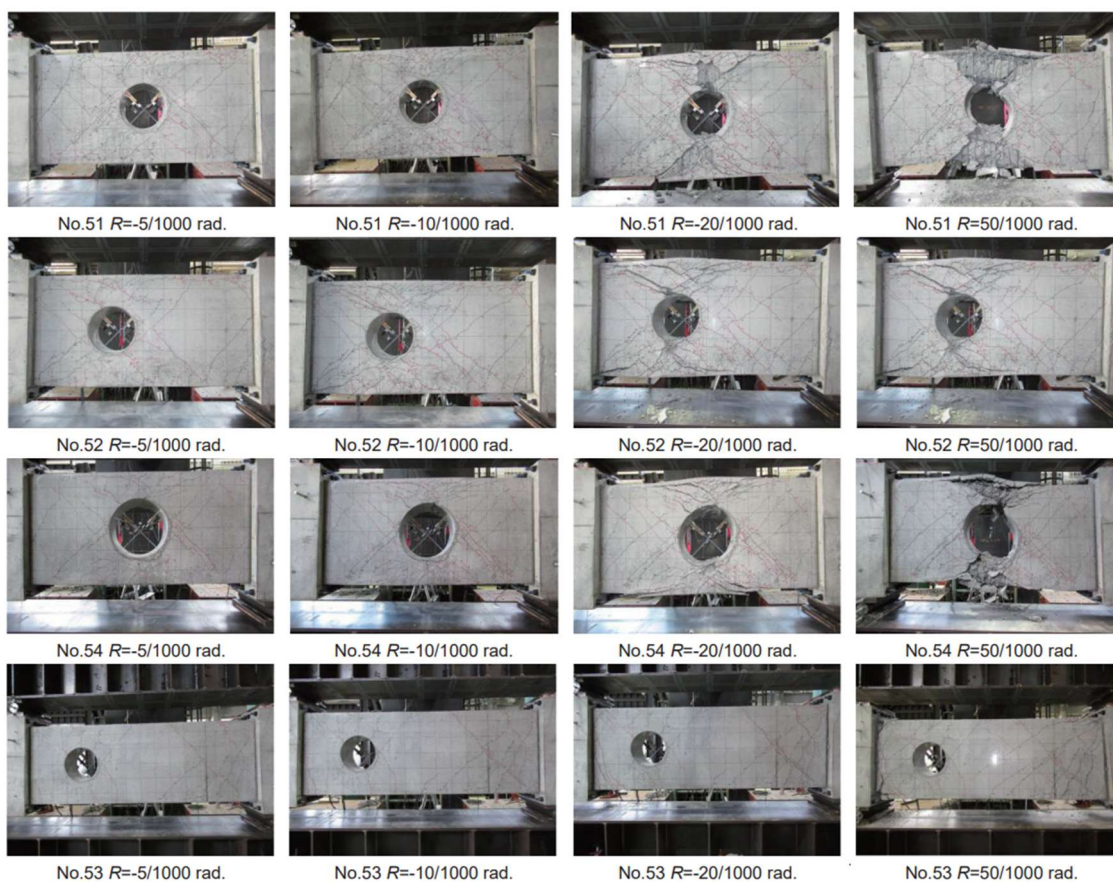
ひび割れ発生と破壊の進行状況
